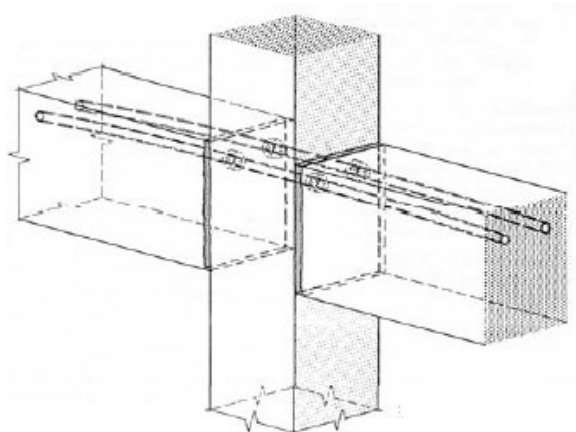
Ligação pilar – viga através de pré-esforço (STUPRÉ, 1981).
